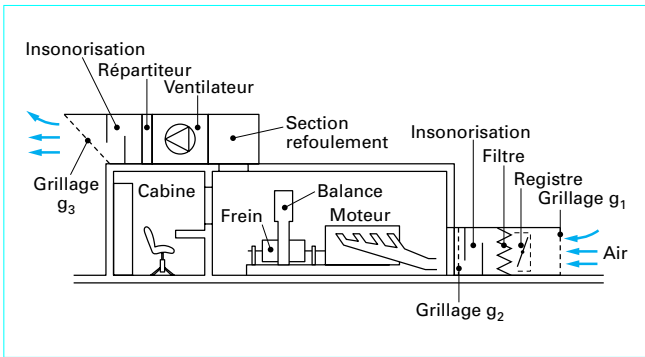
Schéma de l'installation de ventilation d'un banc d'essai de moteur alternatif
